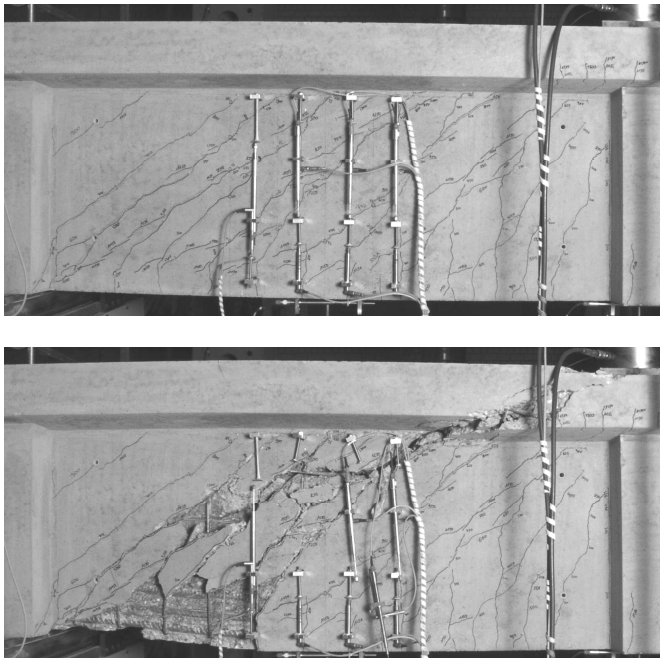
oben: Rissbild unmittelbar vor dem Bruch; unten: abschließendes Bruchbild (Ansicht der Trägerrückseite).
